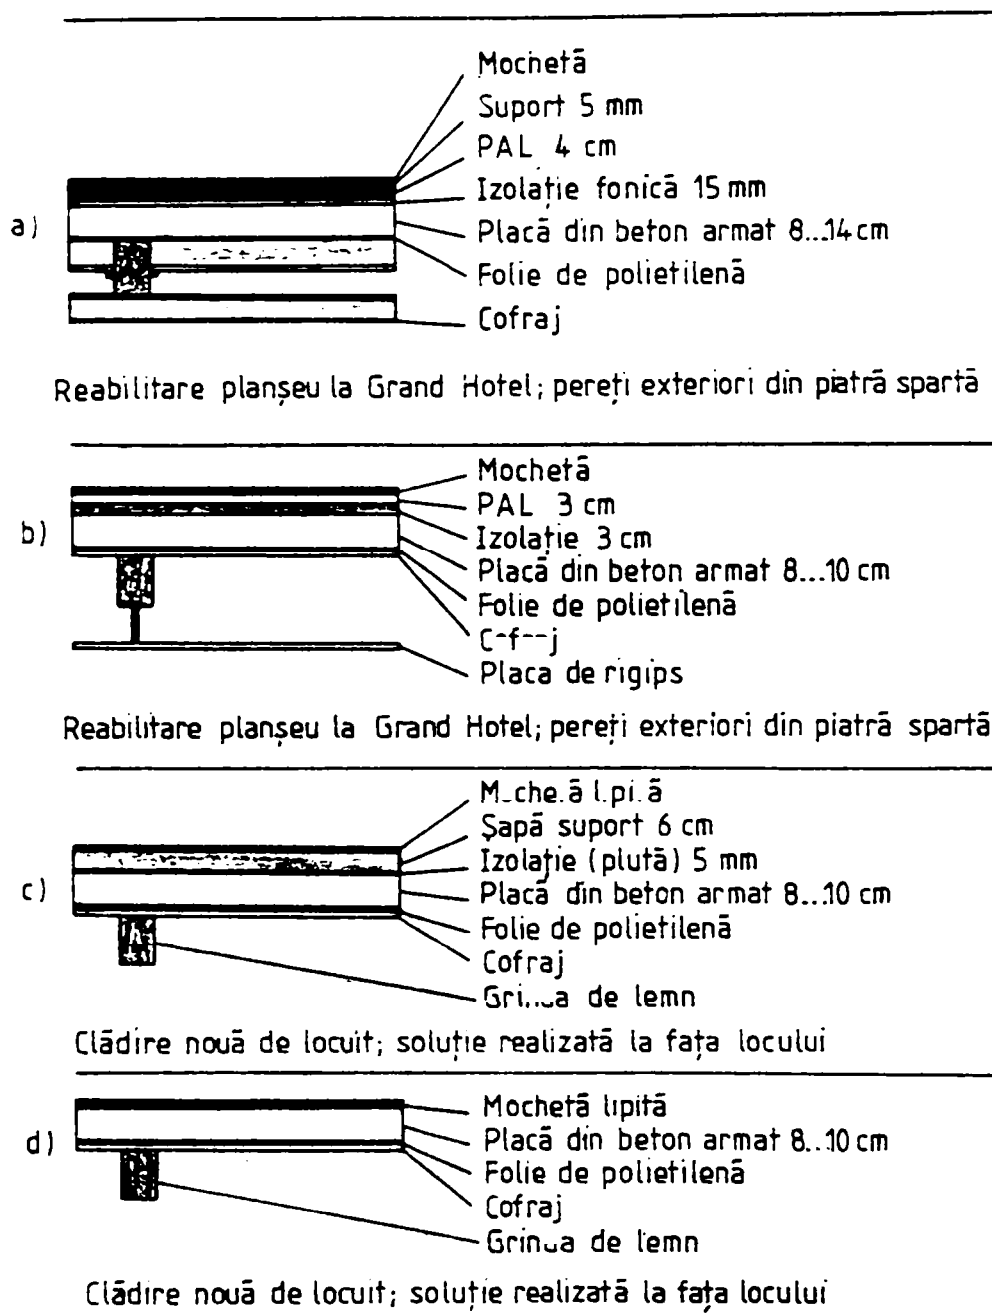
Soluții de realizare a planșelor compuse lemn-beton
